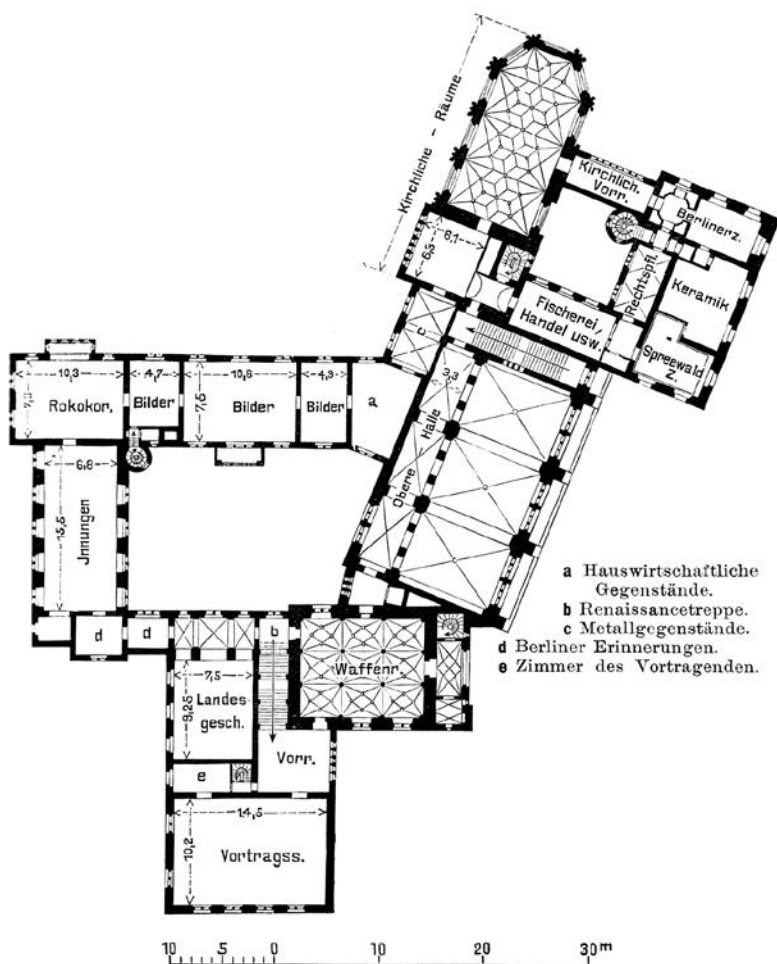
Märkisches Museum Berlin, Grundriss des 2. Obergeschosses
